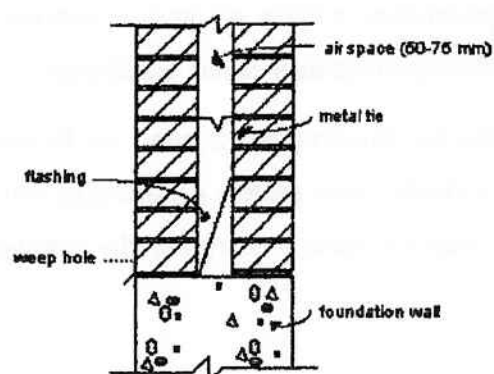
Seção transversal de uma “cavity wall” em alvenaria.
